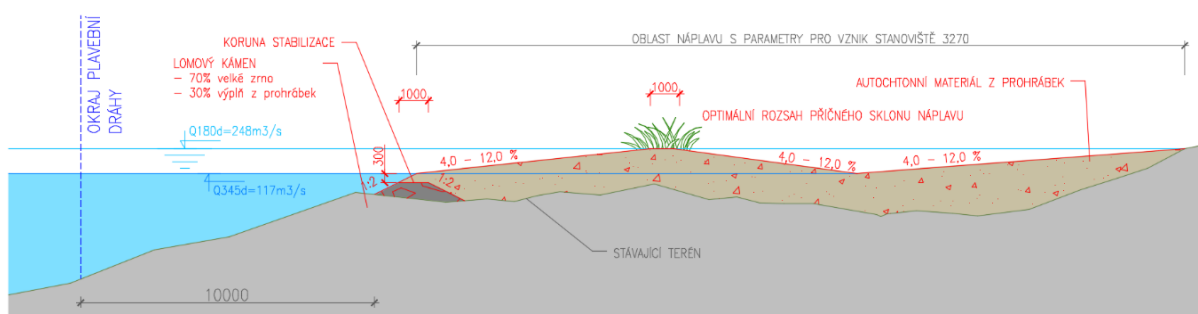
Situace naplav se stabilizační patou - protékaná varianta - odsun břehu
